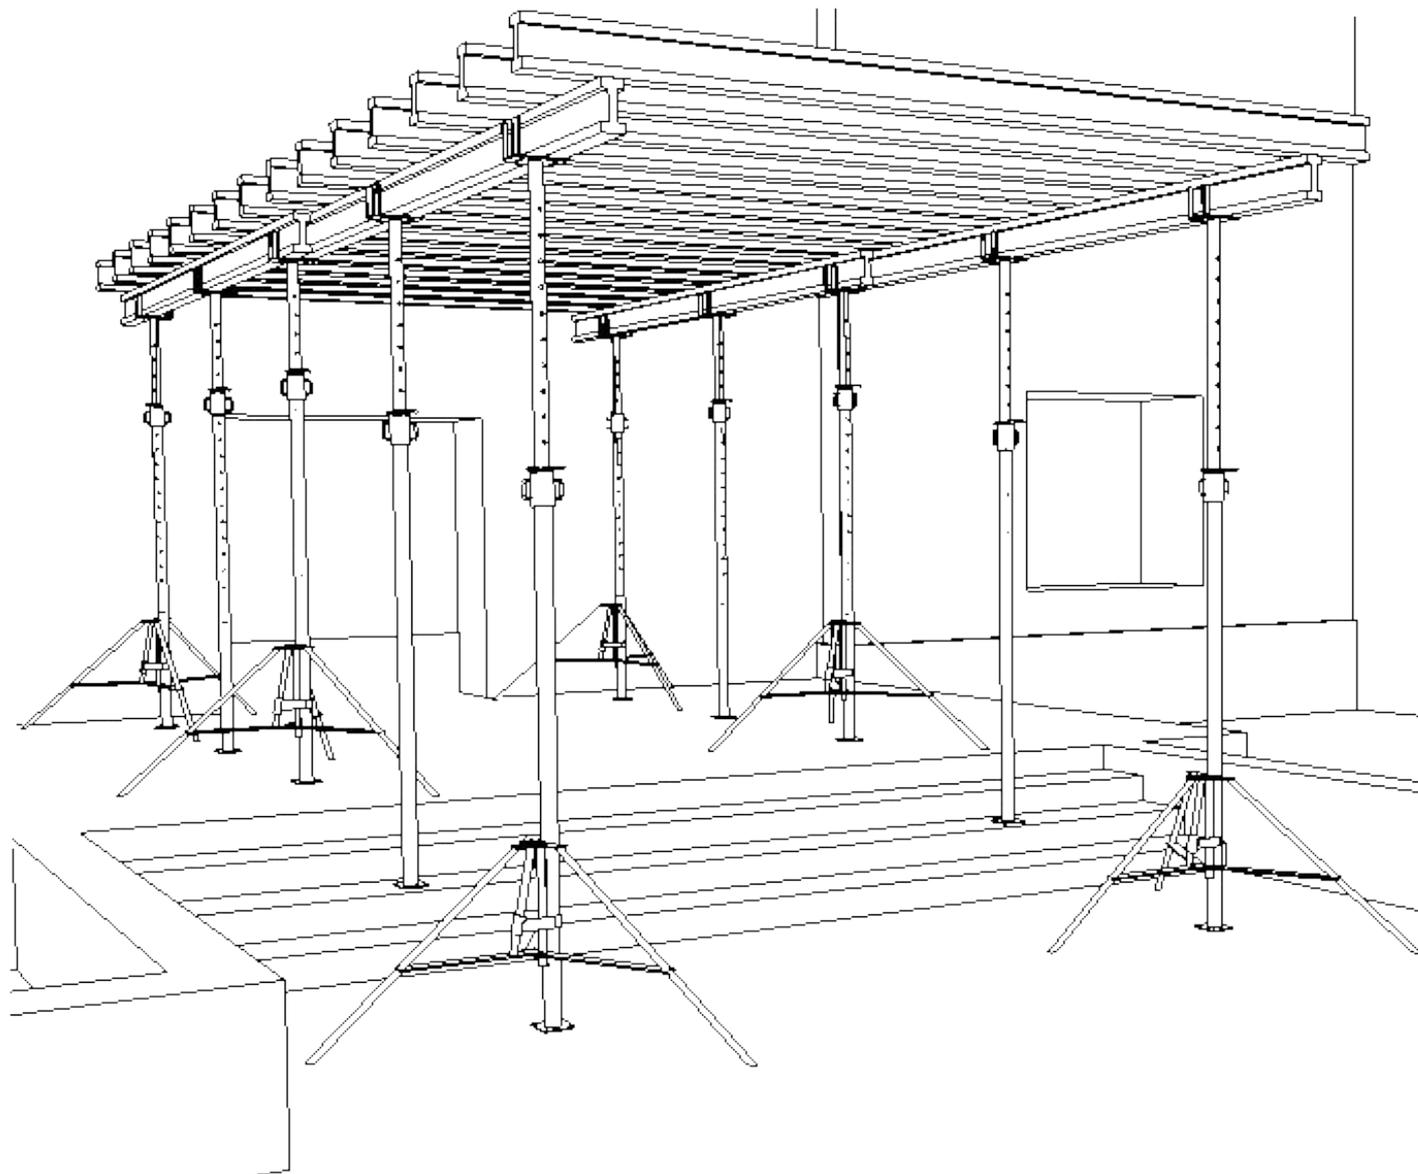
Общий вид опалубки перекрытий с использованием телескопических стоек
